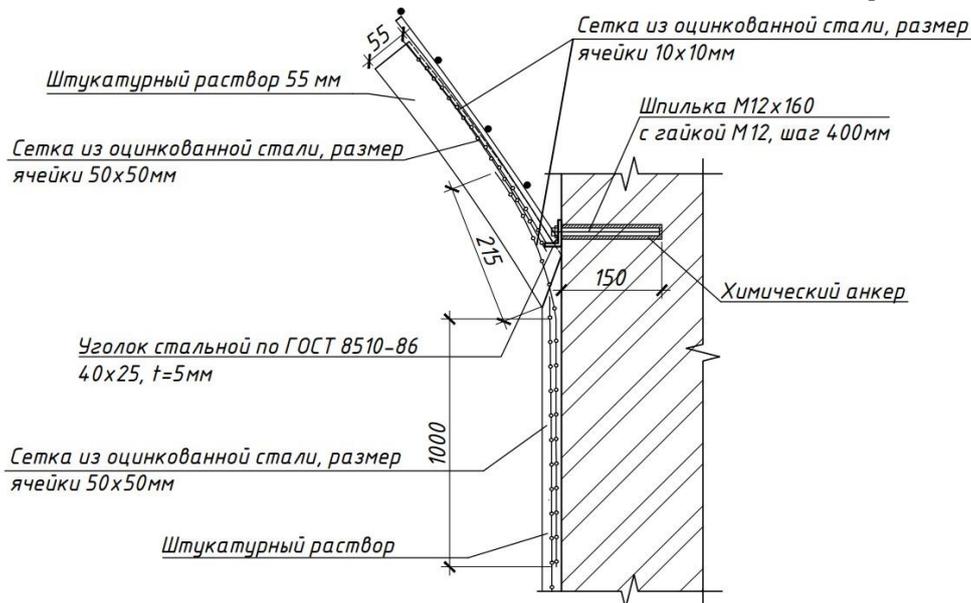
Узел крепления каркаса ложного свода к кирпичным стенам
